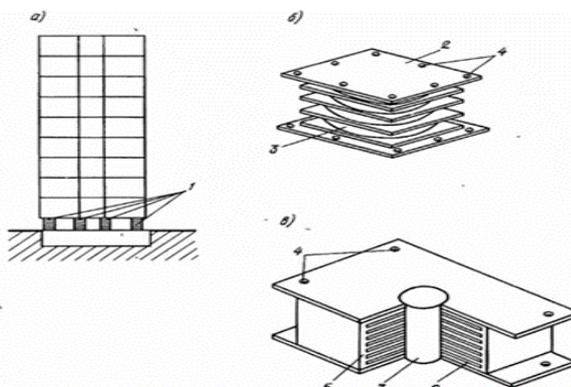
Сейсмоизоляция здания с помощью резинометаллических опор: а - схема установки опор; б, в - схемы конструкции опоры; 1-опоры, 2-стальная плита, 3-слой неопрена;4-отверстие для болтов; 5-резина; 6-сталь; 7-свинец.
